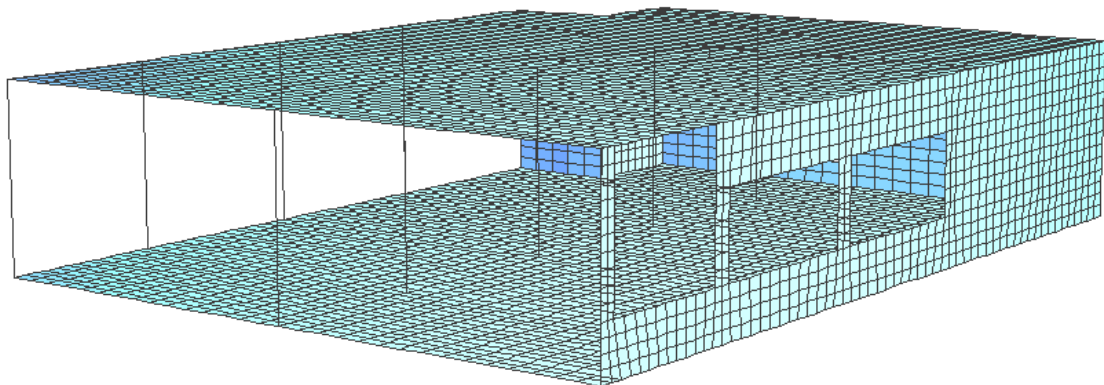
Eingeschossiger Anbau, BV Schlosserei, Holzgerlingen
